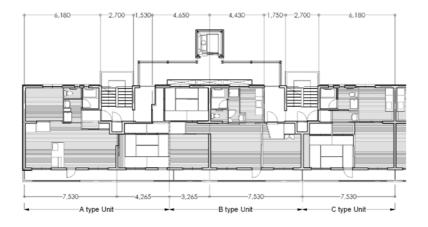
改修後の平面図(西側 2 階段)/ Building Floor Plan (West Part) after Renovation
